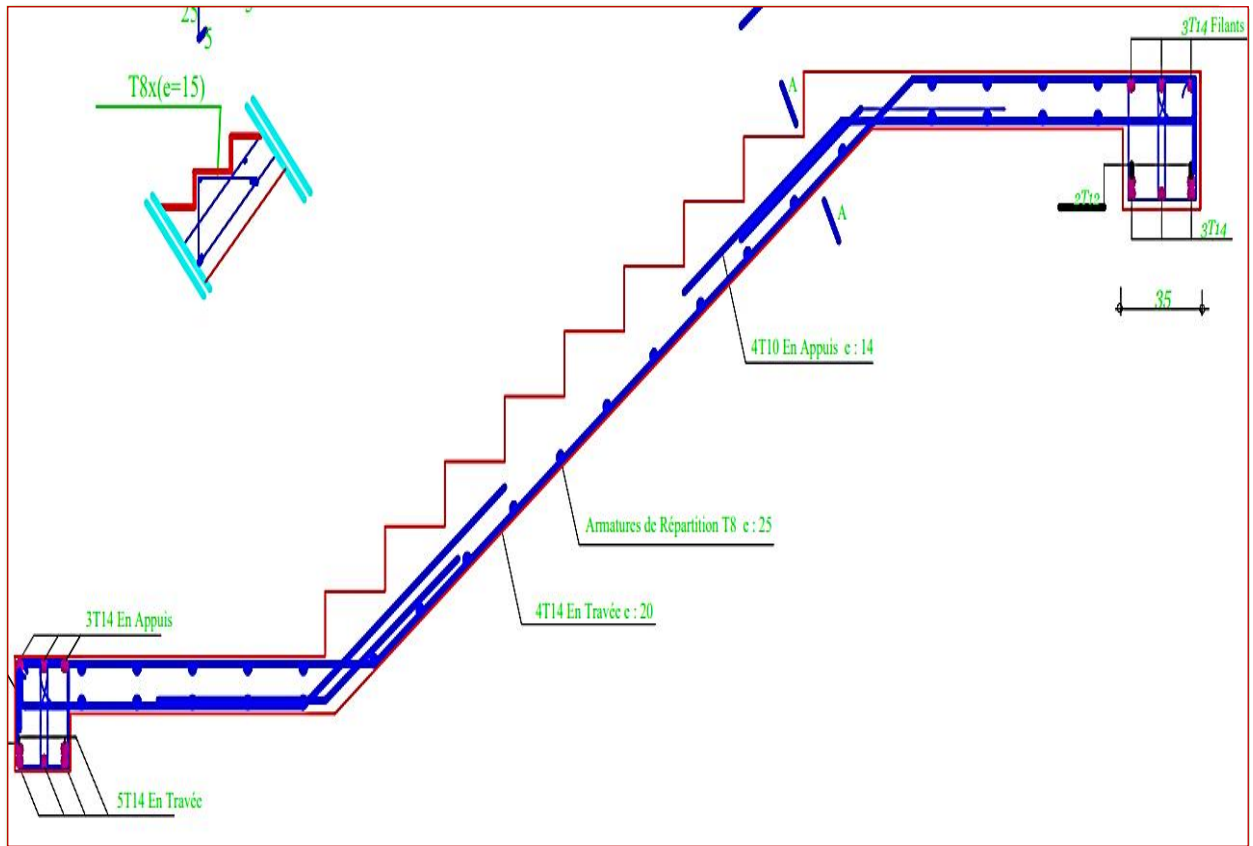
Schéma de ferrailage de l'escalier Type 1
